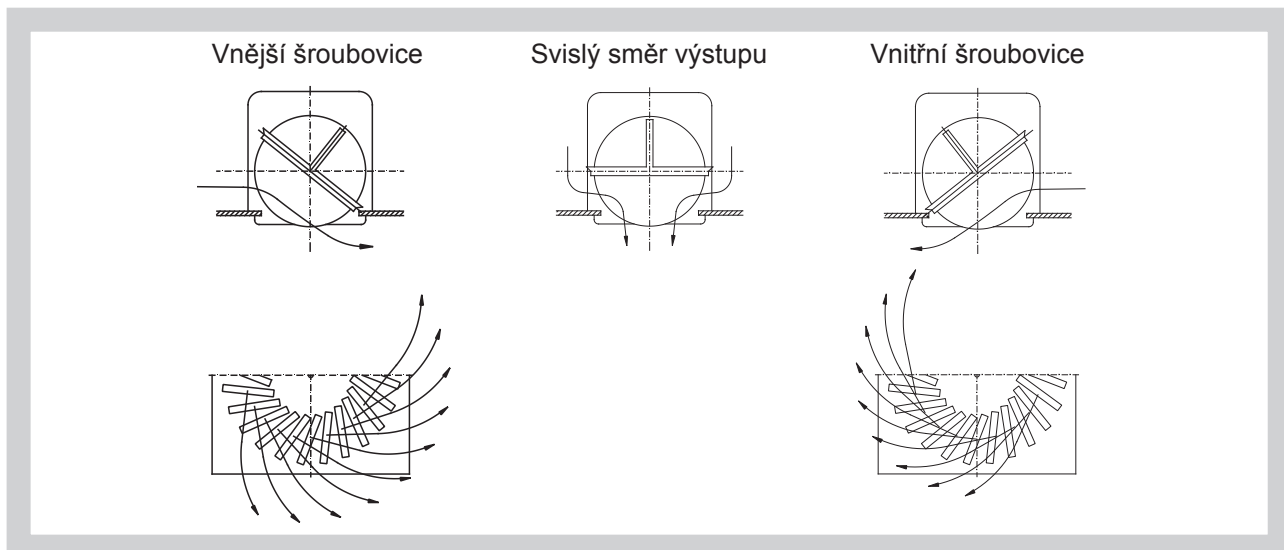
Provedení VVM/K - Čelní deska kruhová
